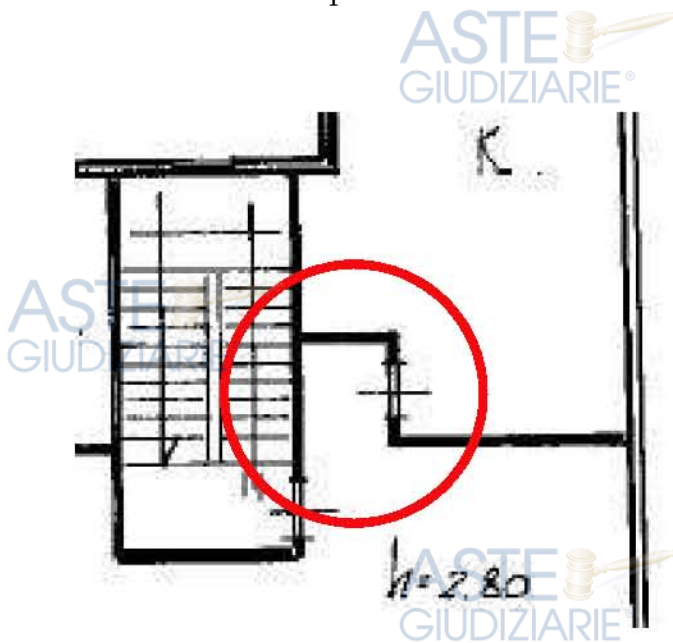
Rappresentazione della parete del vano cucina come da planimetria catastale
